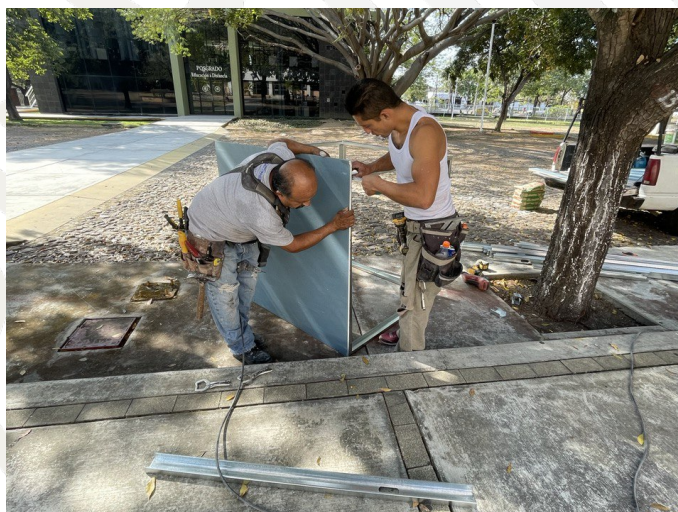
Proceso de armado de perfilaría de aluminio, Fuente: Propia.
